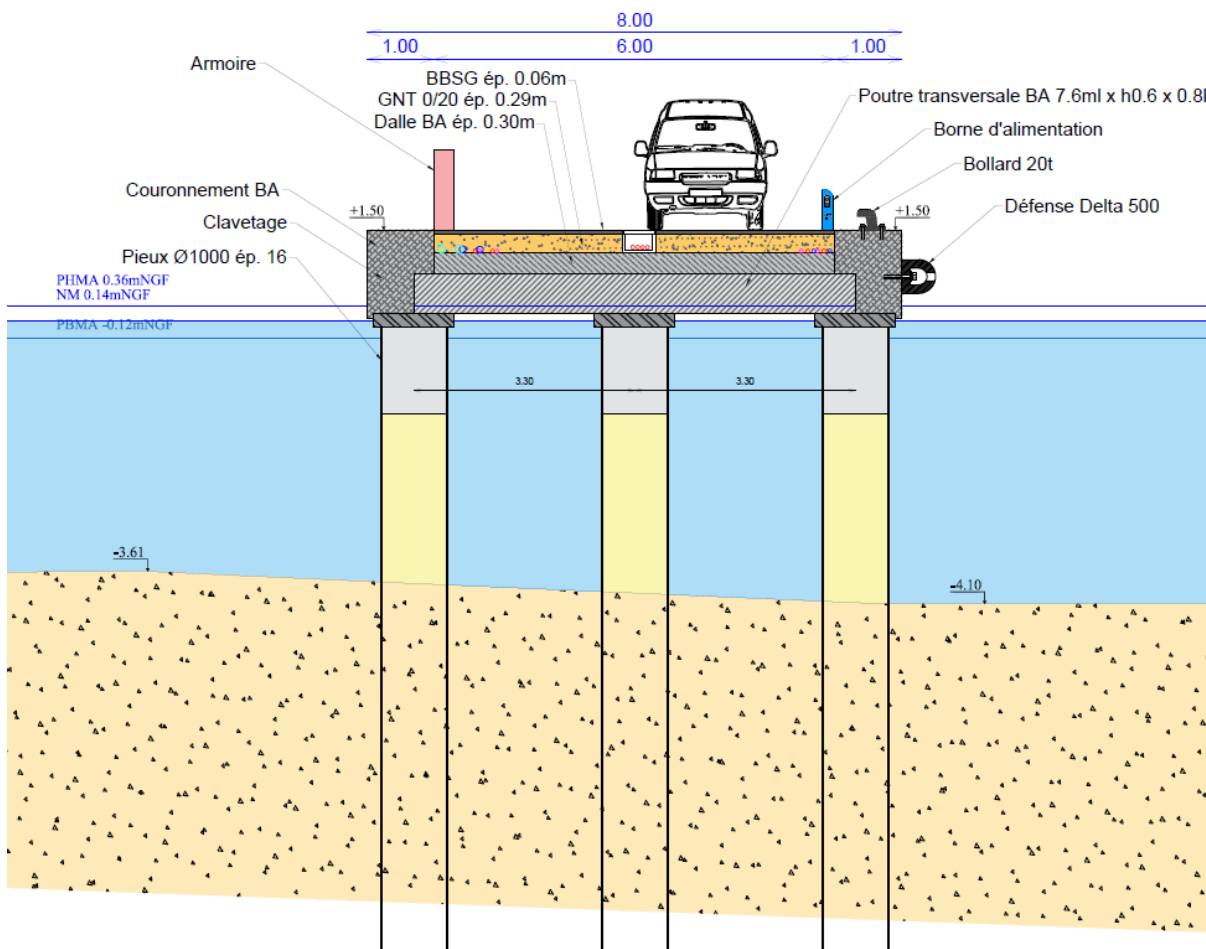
Coupe de principe de l'ouvrage sur pieux (SUEZ, AVP 2024)
